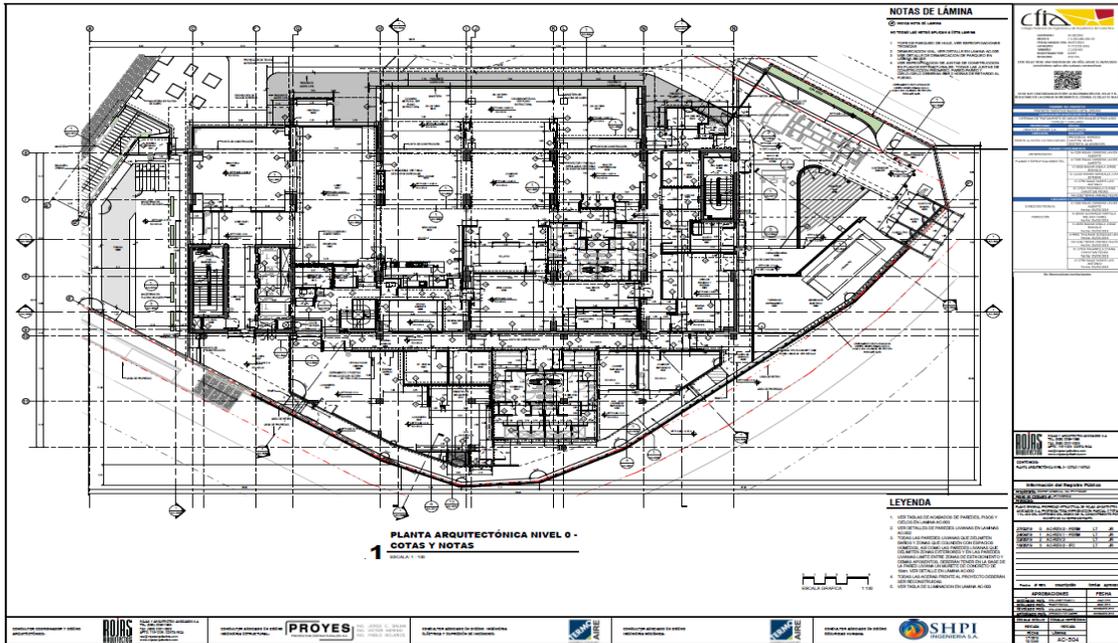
Planta de Conjunto Nivel, referencia planos constructivos, lámina # AC-504
